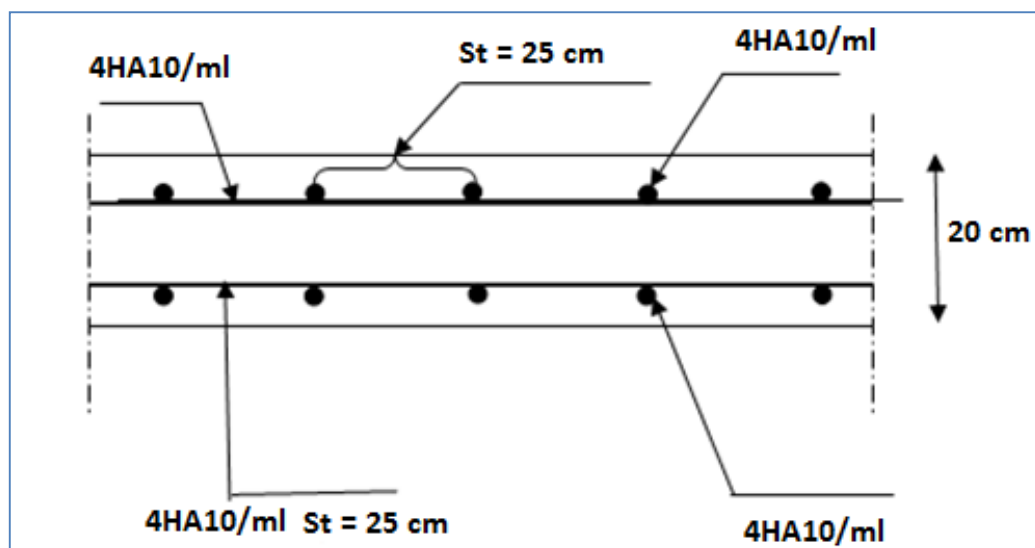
Ferrailage de la dalle pleine de la salle machine dans le sens x-x
